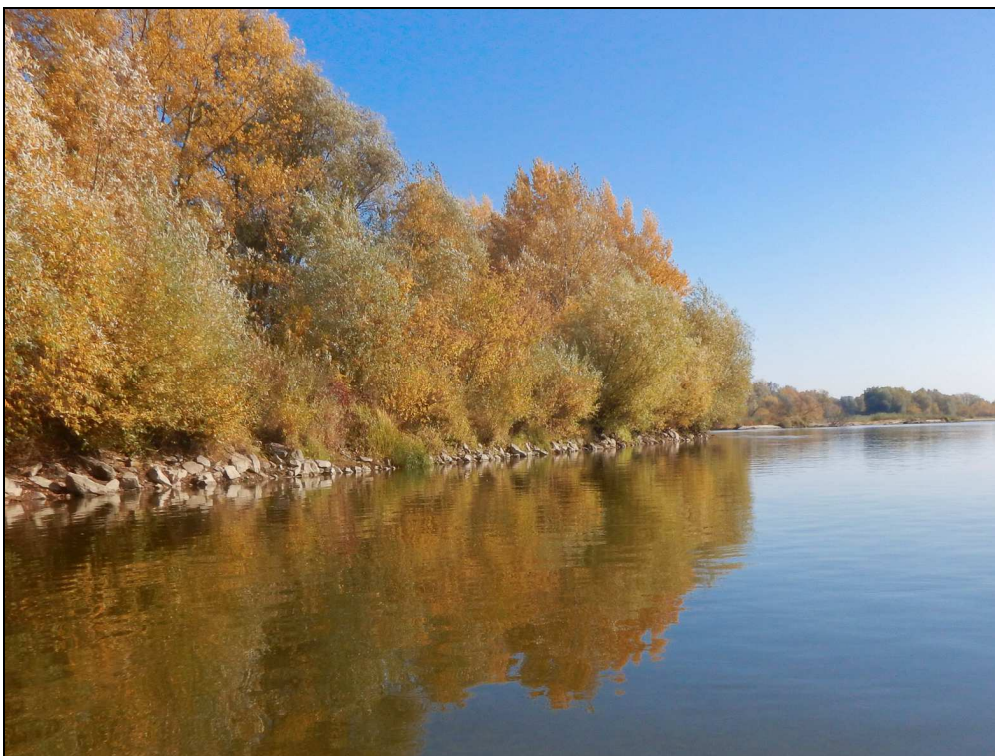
Opaska brzegowa widok w kierunku przekroju P-4
